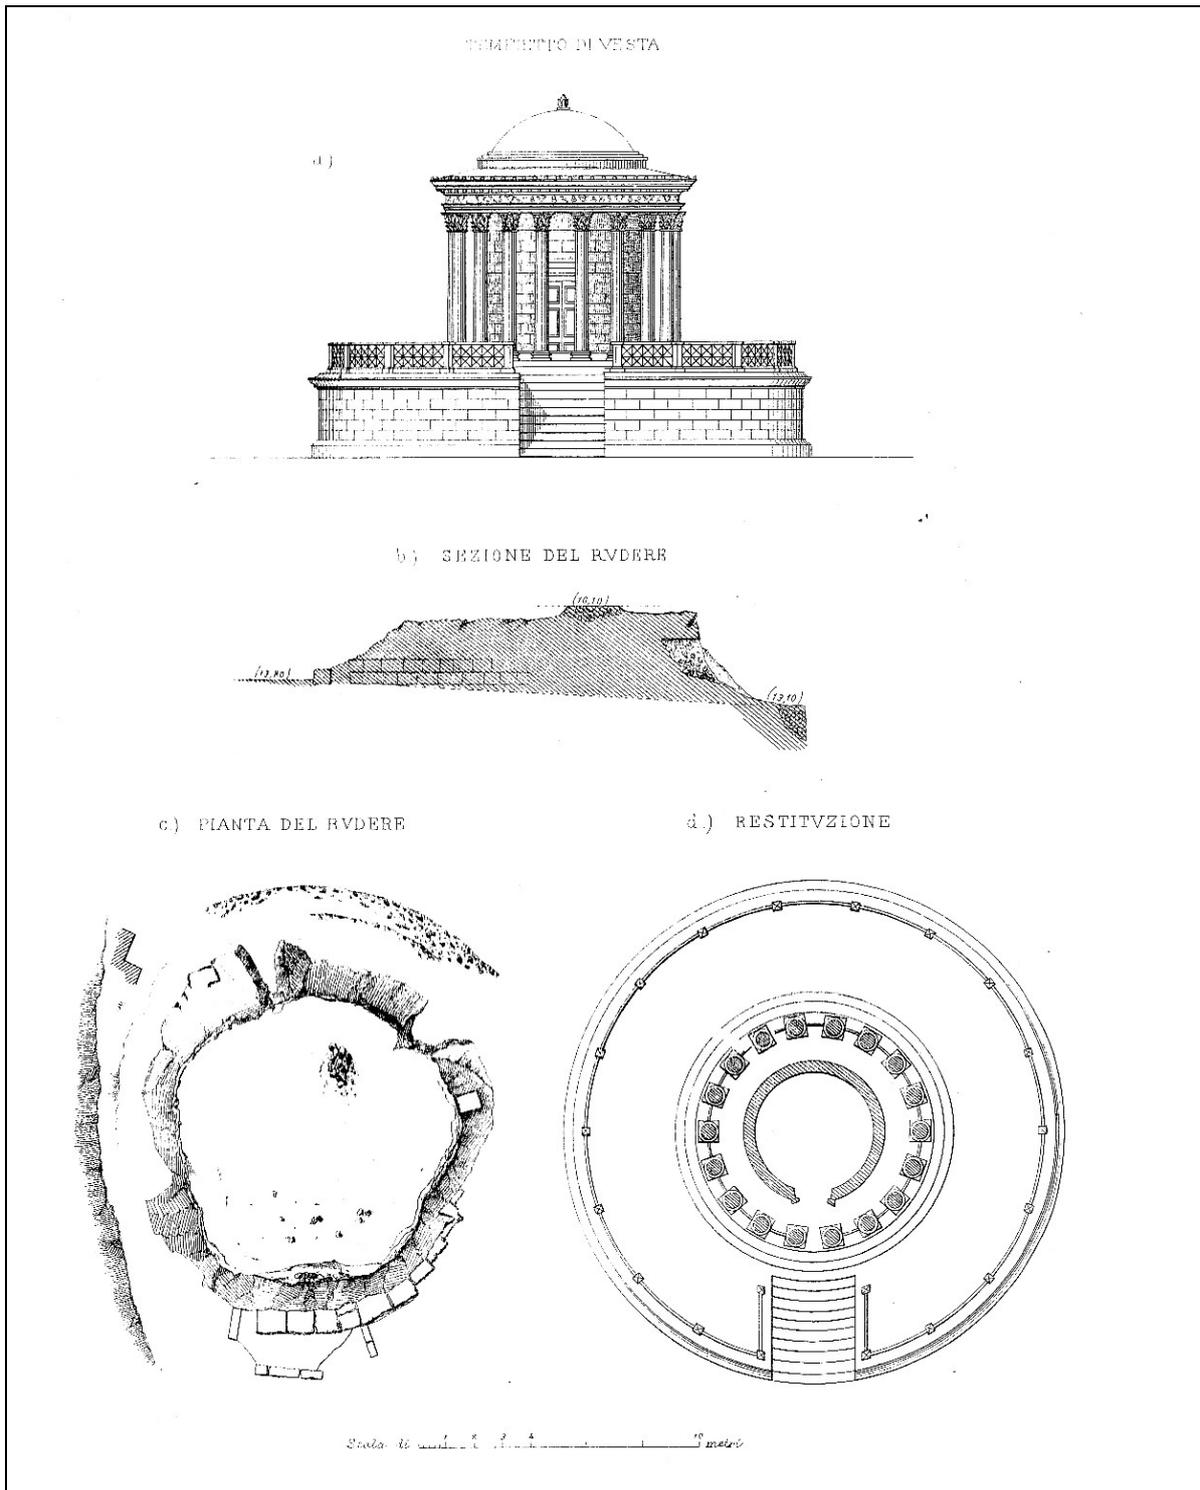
Prospetto e pianta del Tempio di Vesta nel Foro Romano
